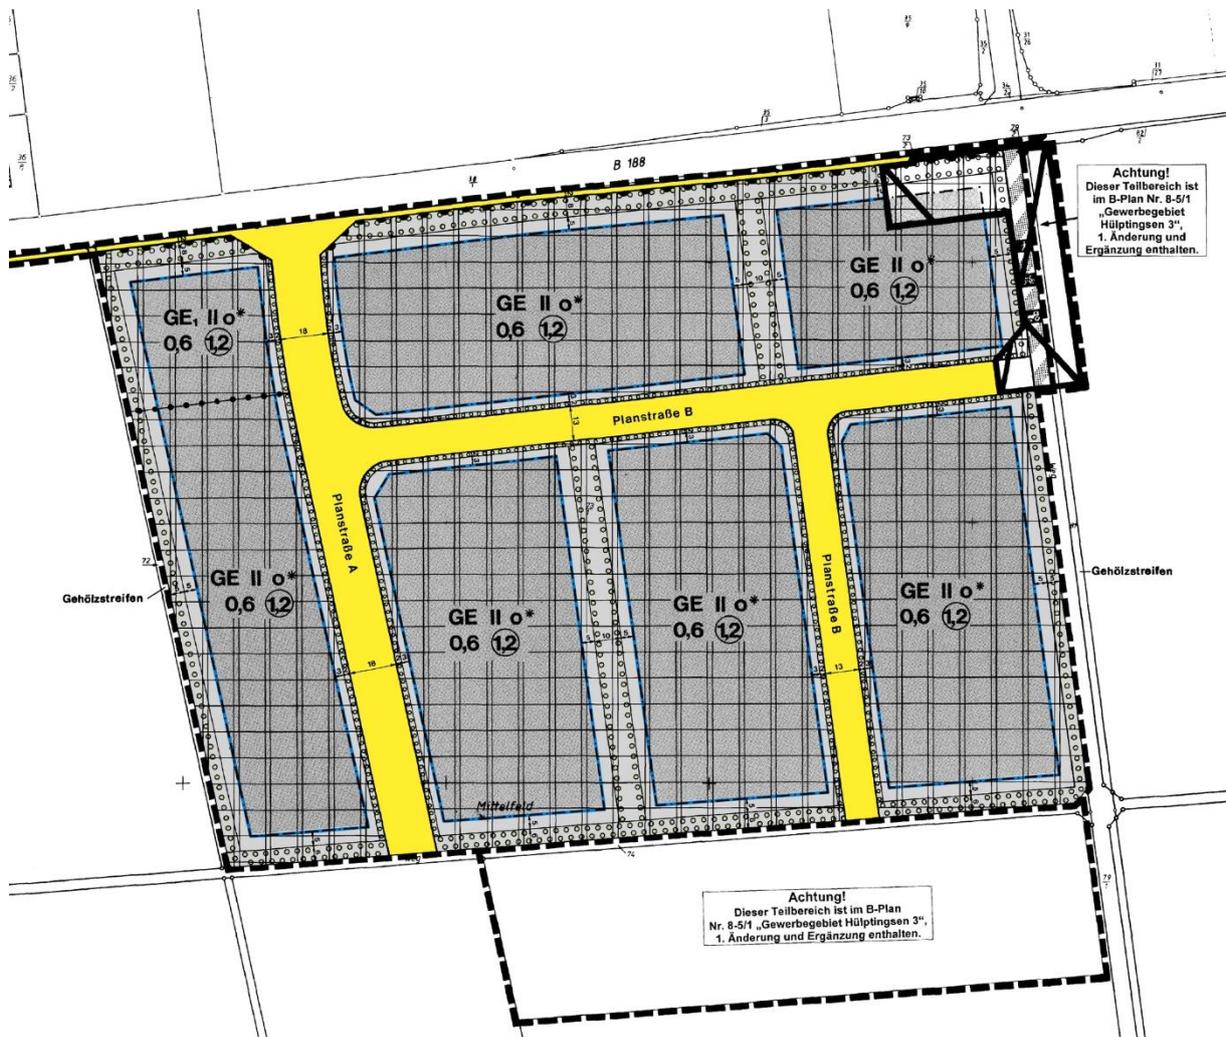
Bebauungsplan Nr. 8-05 "Gewerbegebiet Hülptingsen 3"
